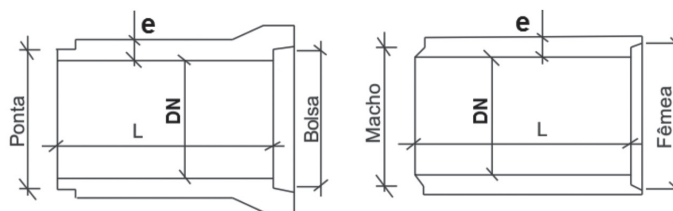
Corte longitudinal de tubos com encaixe ponta e bolsa e macho e fêmea
